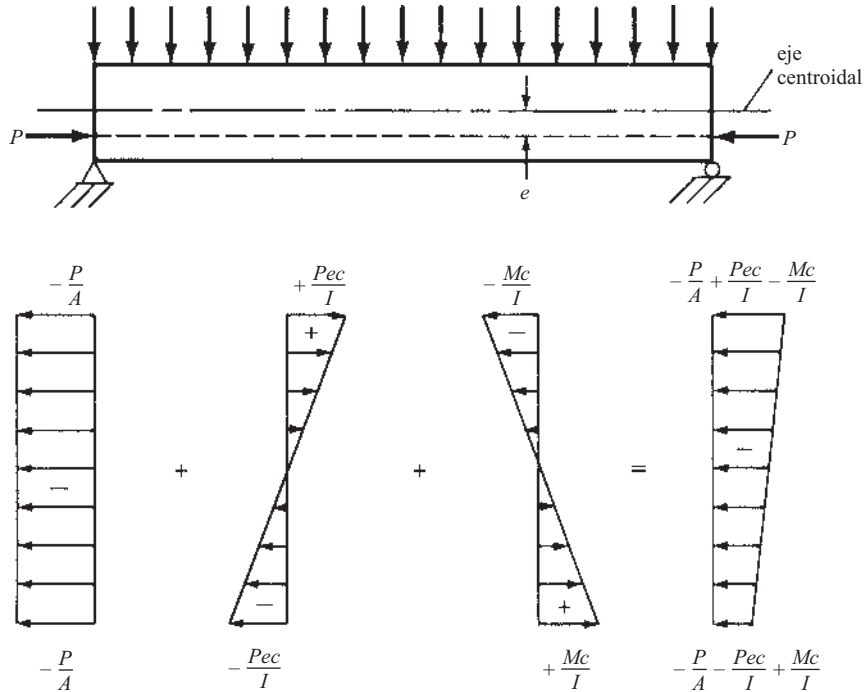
Distribución de esfuerzos en el concreto provenientes de la fuerza de presforzado excéntrica y de las cargas sobrepuestas.
